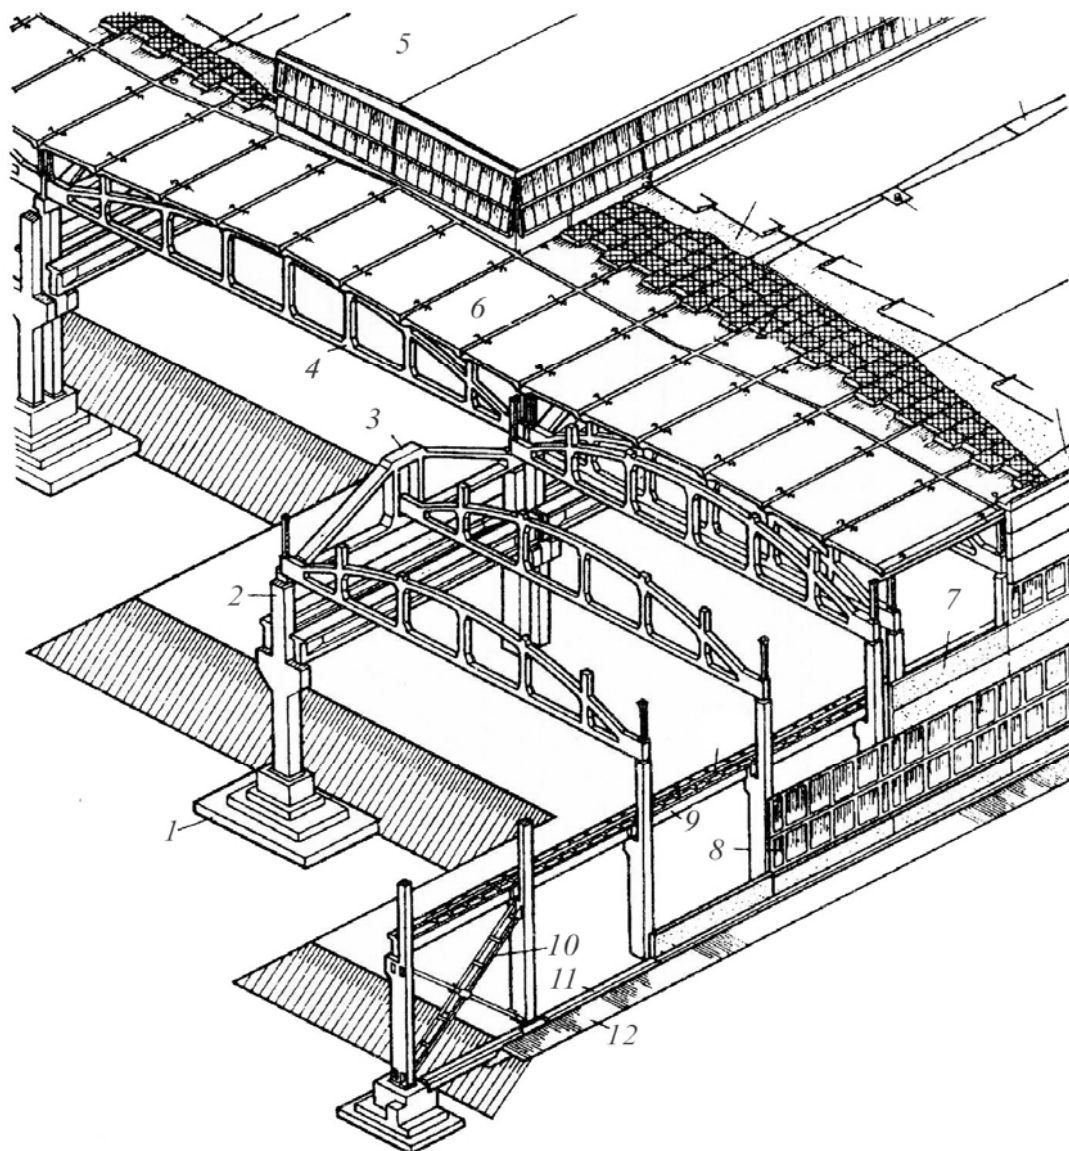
Конструктивные элементы одноэтажного здания с железобетонным каркасом:
